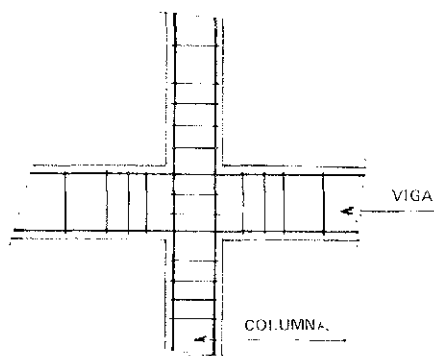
Nudo ductilizado de concreto armado en base a una concentración de estribos.
